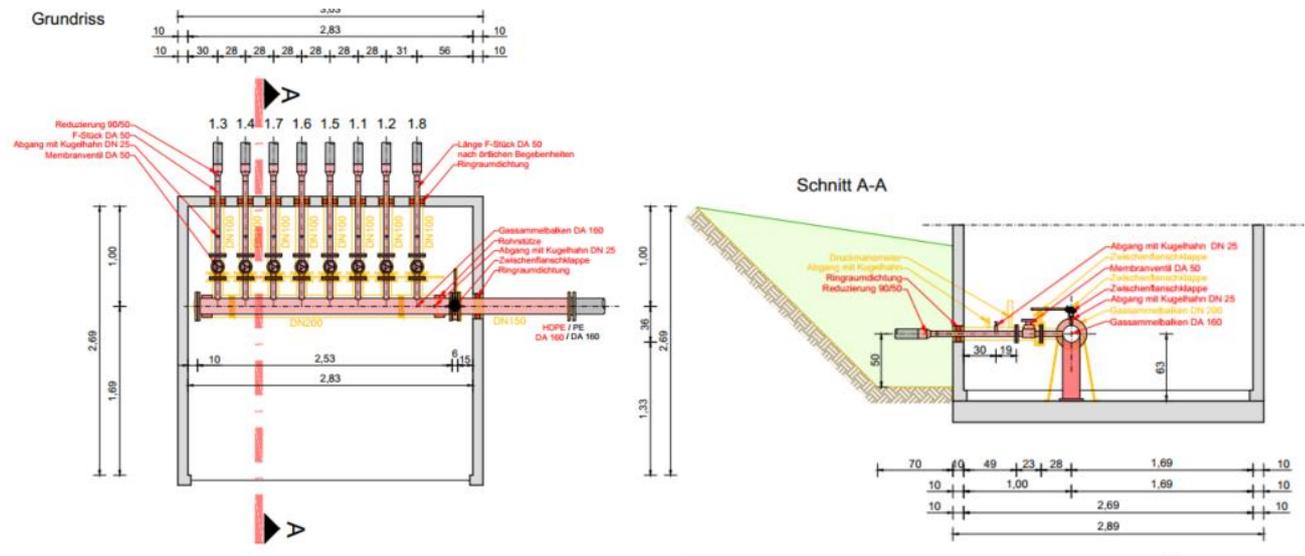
Umbau der Gasregelstationen am Beispiel der GRS1: Grundriss und Schnitt
